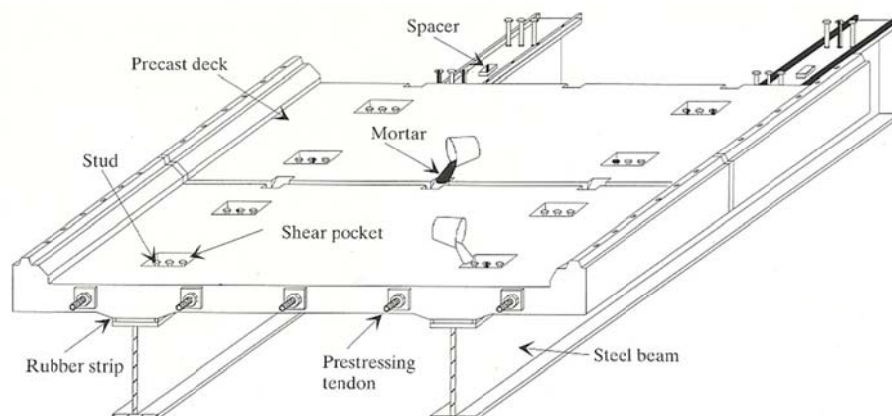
Rebaixos para conectores e aplicação de *grout* nas juntas. Tradução: *Precast Deck* (Laje Pré-fabricada), *Mortar* (Argamassa), *Shear Pocket* (Rebaixo para Cisalhamento), *Steel Beam* (Viga d'Aço), *Prestressing Tendons* (Cabos de Protensão), *Rubber Strip* (Tira de Borracha), *Spacer* (Espaçador) (SHIM et al., 2010)
